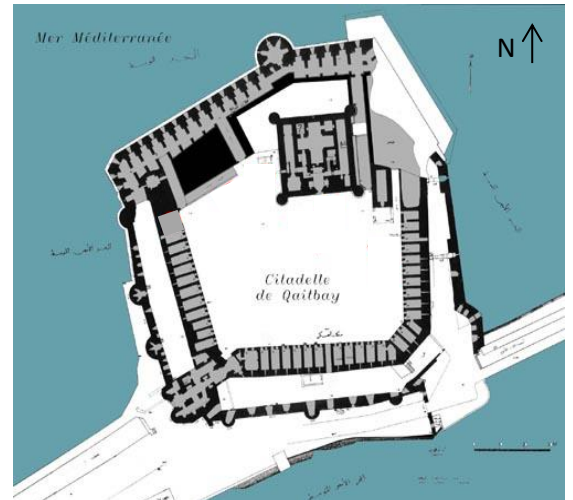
Plan de la citadelle de Qait-bay, source : <http://www.cealex.org>
